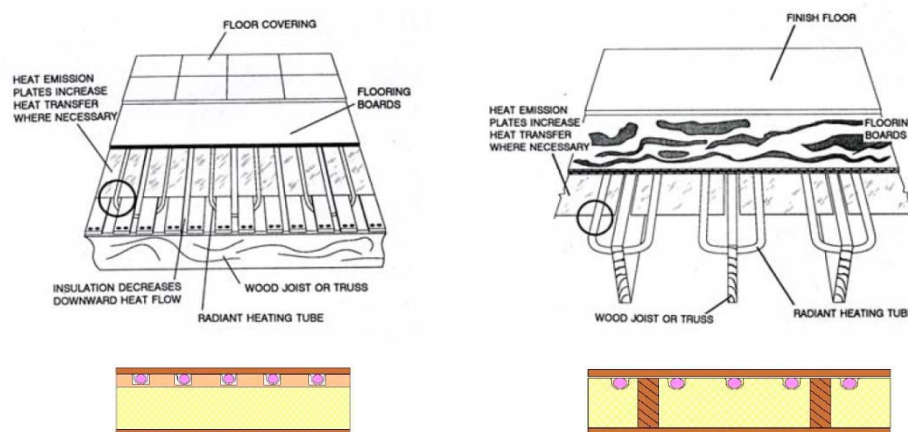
Sistemas superficiales embebidos sobre construcciones de madera. Fuente: [CEN EN15377 2005]
